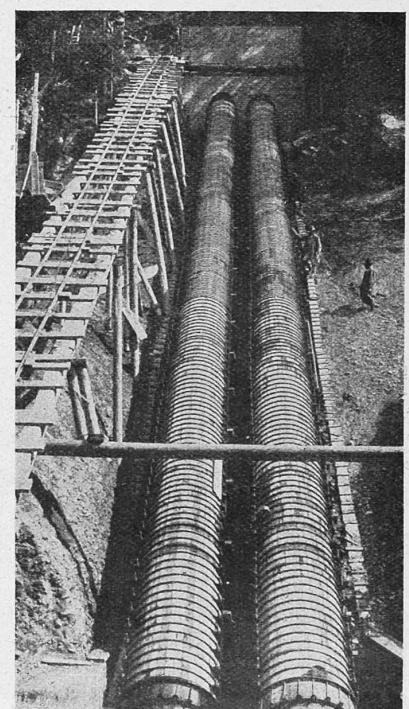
bis 6. Verschiedene Baustadien der hölzernen Druckleitung der Papierfabrik Pöls bei Judenberg, Steiermark. — Durchmesser 1300 mm, Länge je 41,5 m.
